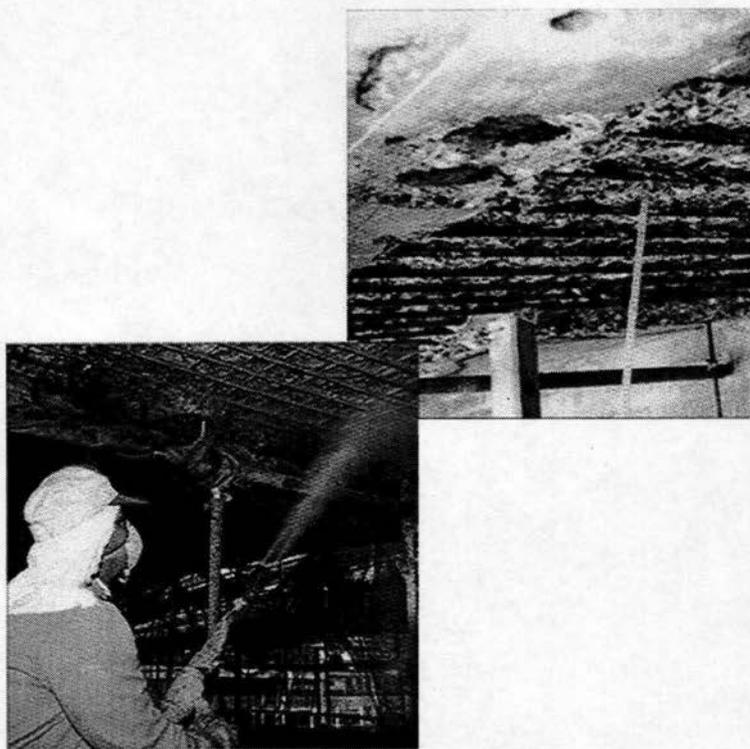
Concreto deteriorado en las barandas y en la cara inferior de la losa del puente debido a la acción de congelamiento/ descongelamiento acelerada por las sales de deshielo.
